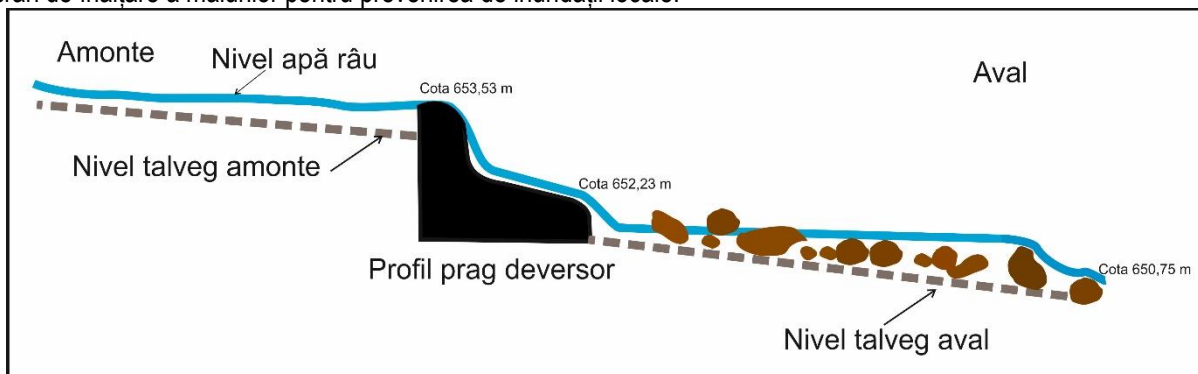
Profil longitudinal Bariera 1 – stare actuală
